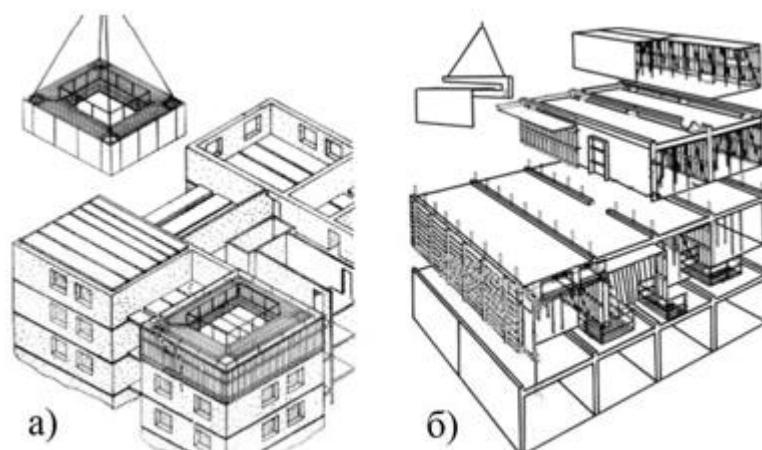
Конструктивні схеми монолітних будівель: а) блокова та великощитова опалубка; б) об'ємно-переставна (тунельна) опалубка
